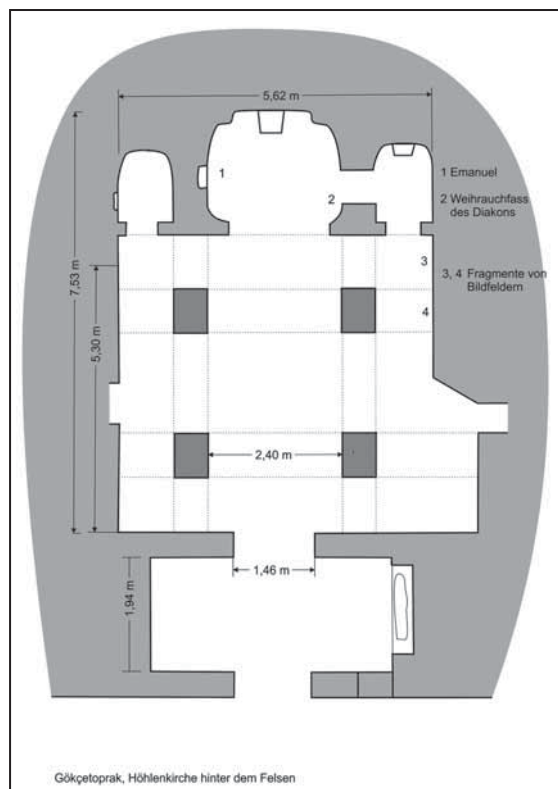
Gökçetoprak, Grundriss der Höhlenkirche.
